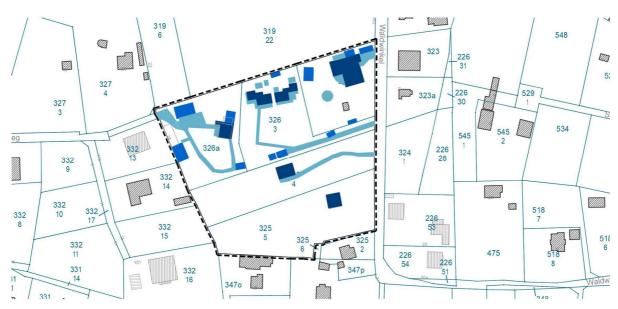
bestehende Flächenversiegelungen im Plangebiet
